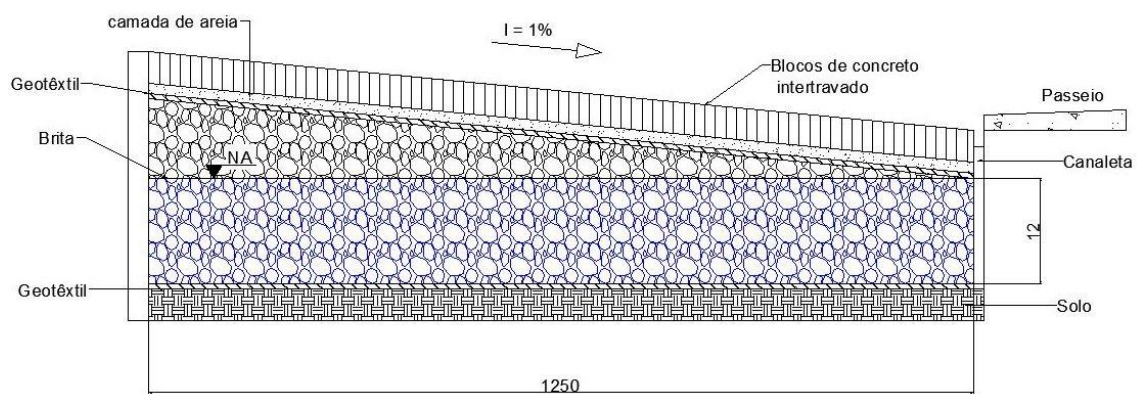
Pavimento permeável corte (Fonte: Autoria própria 2015)
